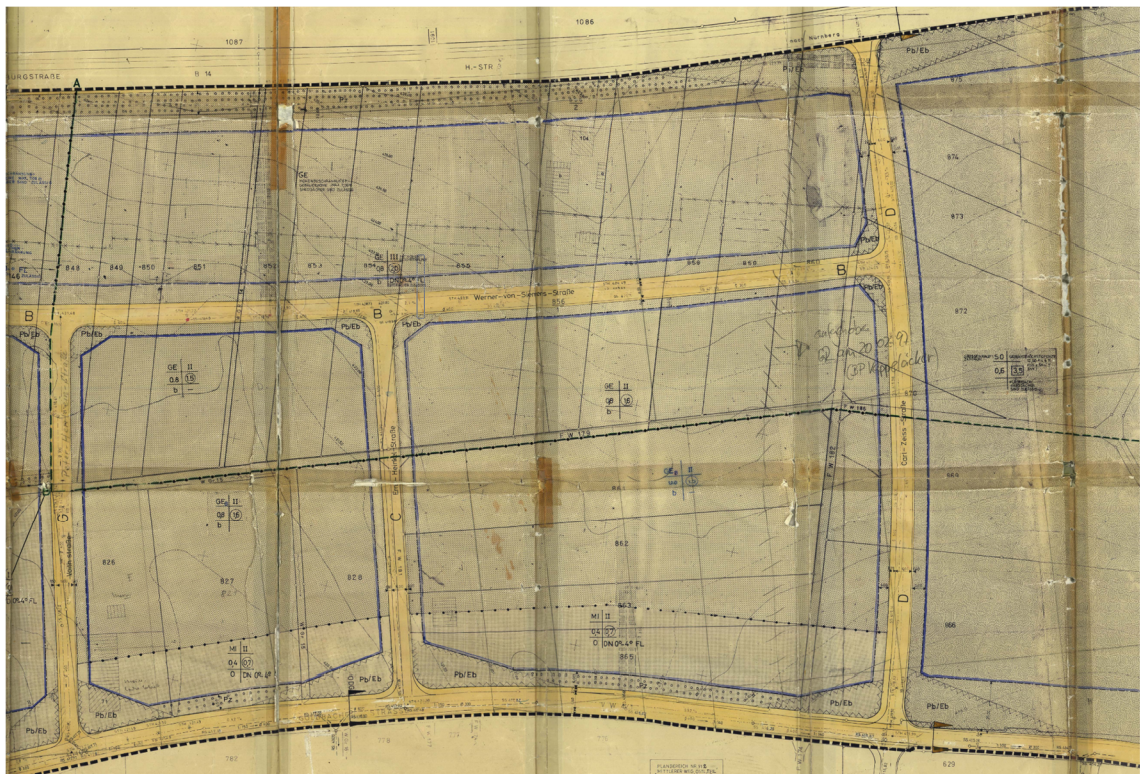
Auszug aus dem Bebauungsplan ‚Schönebürgstraße‘ [18]
